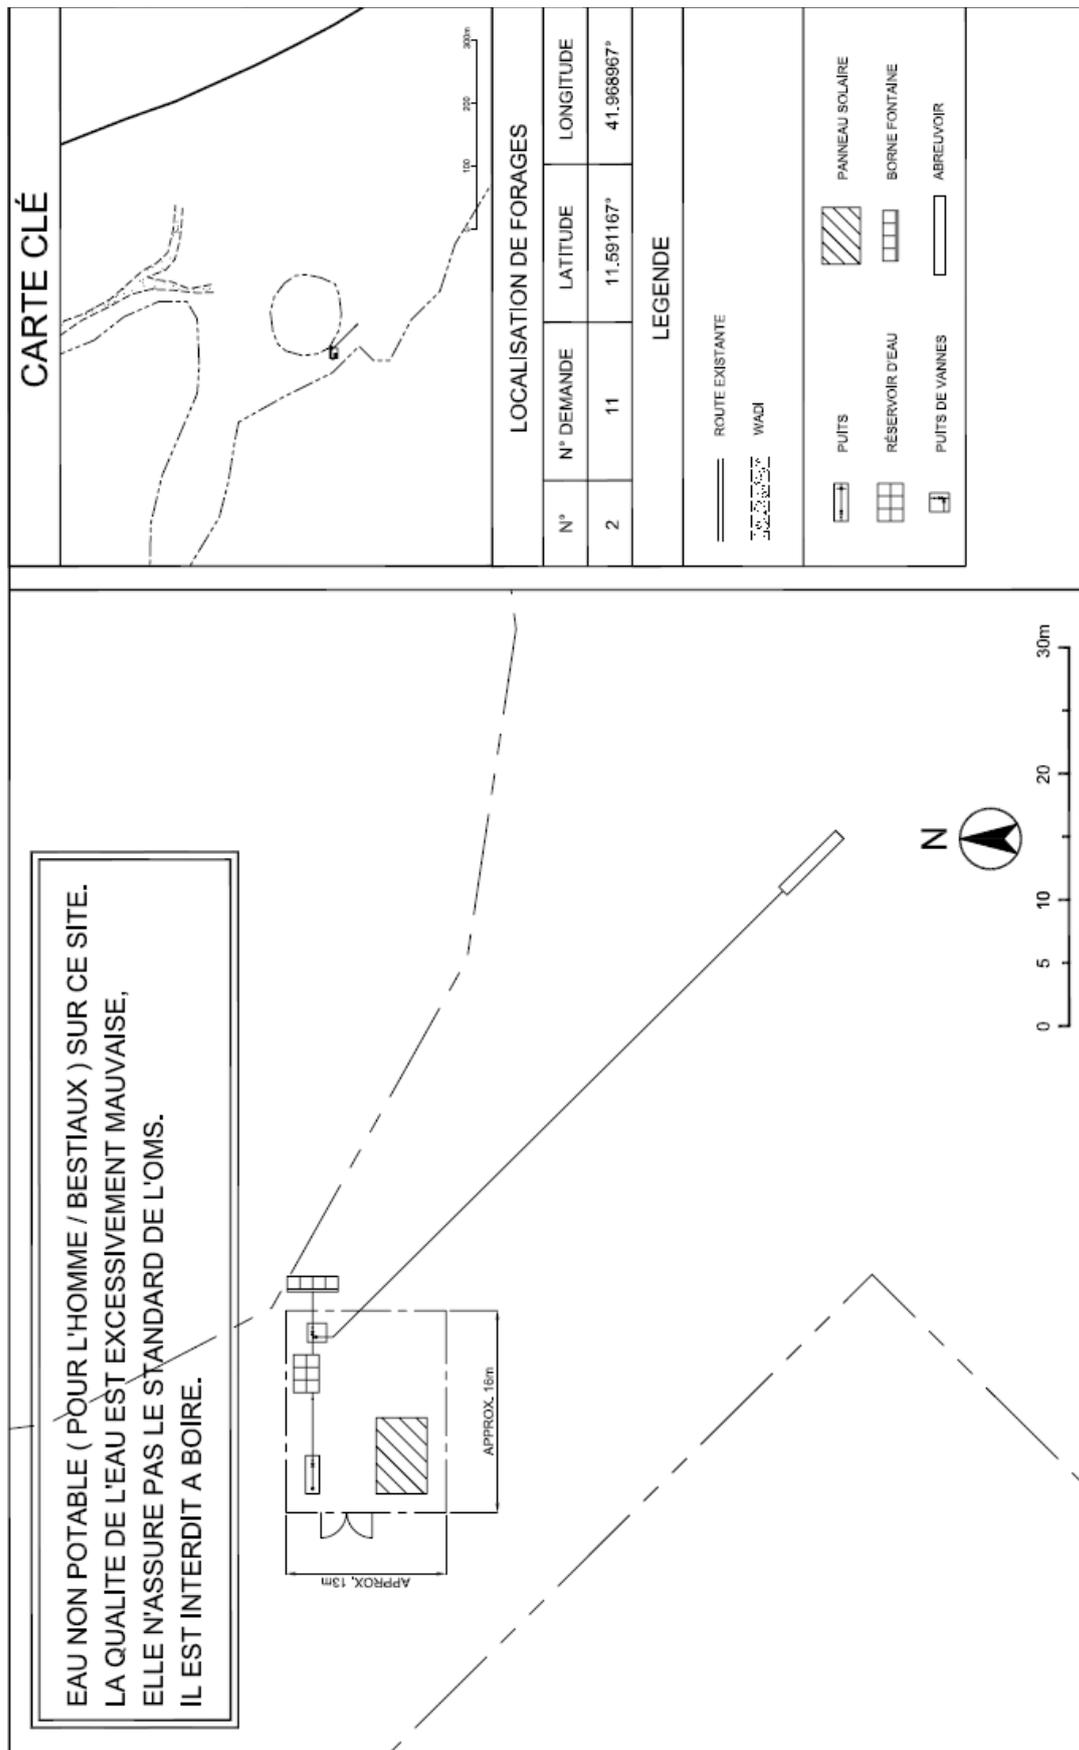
Plan d'implantation des installations (ii) [Daguiro(2)]
